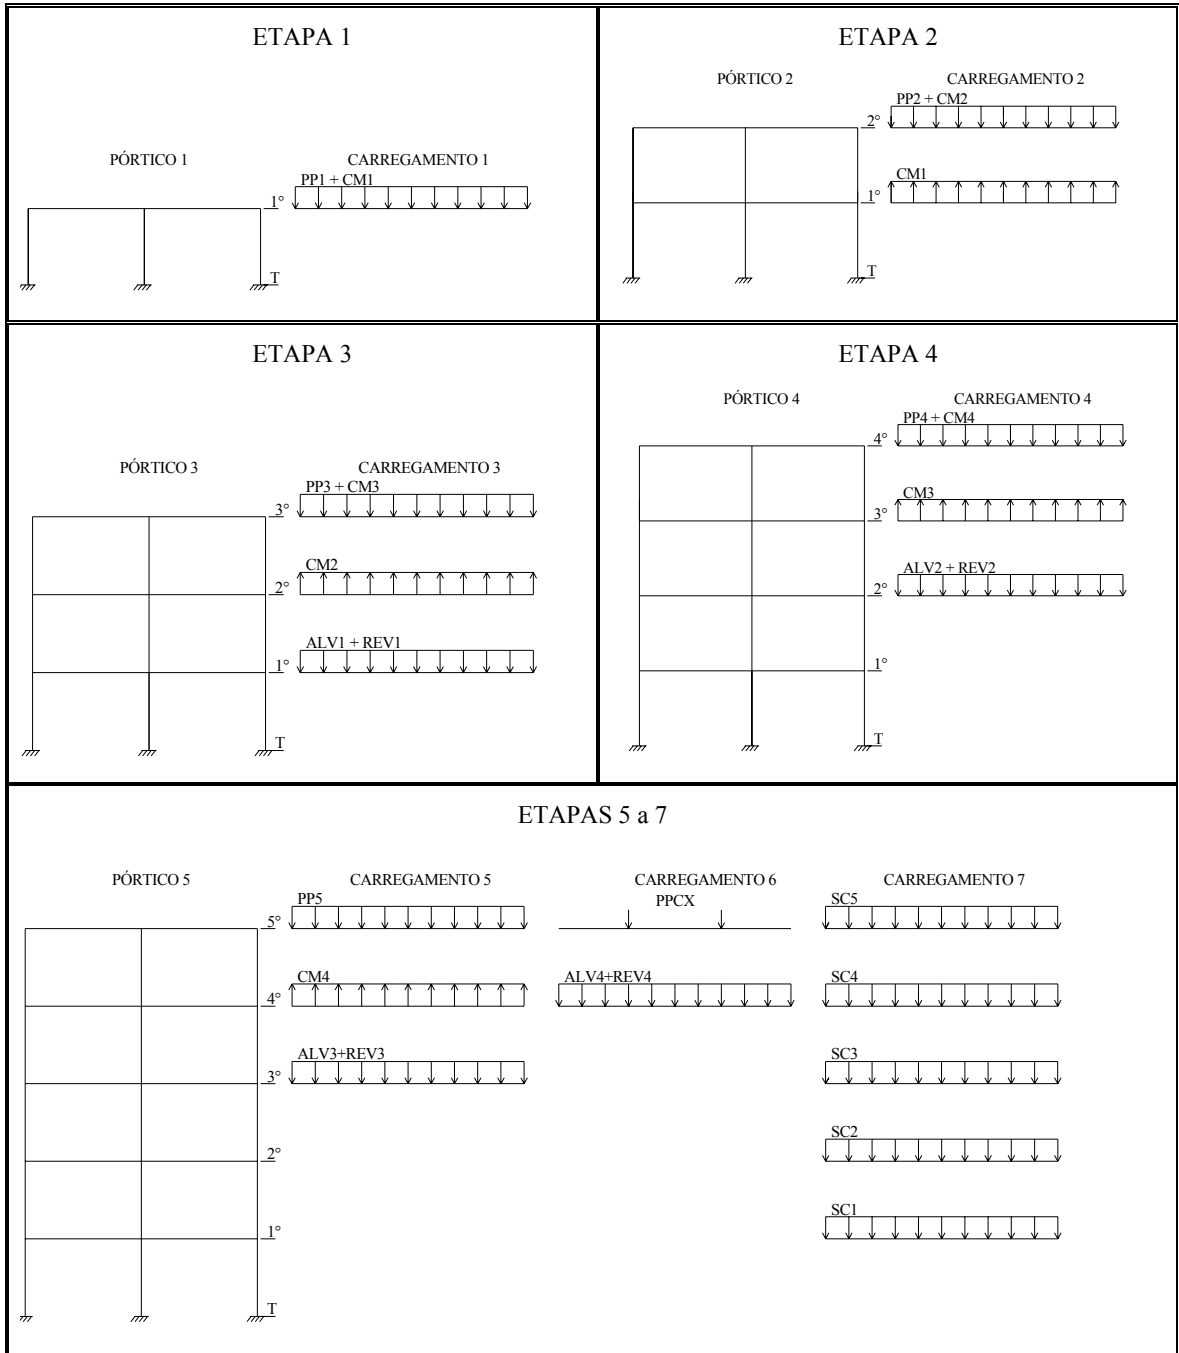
Carregamento vertical para o pórtico plano
